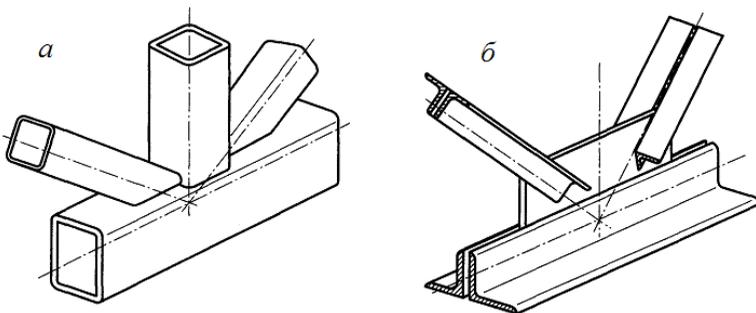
Компонування вузлів ферм: а - безфасонкових; б - фасонкових
